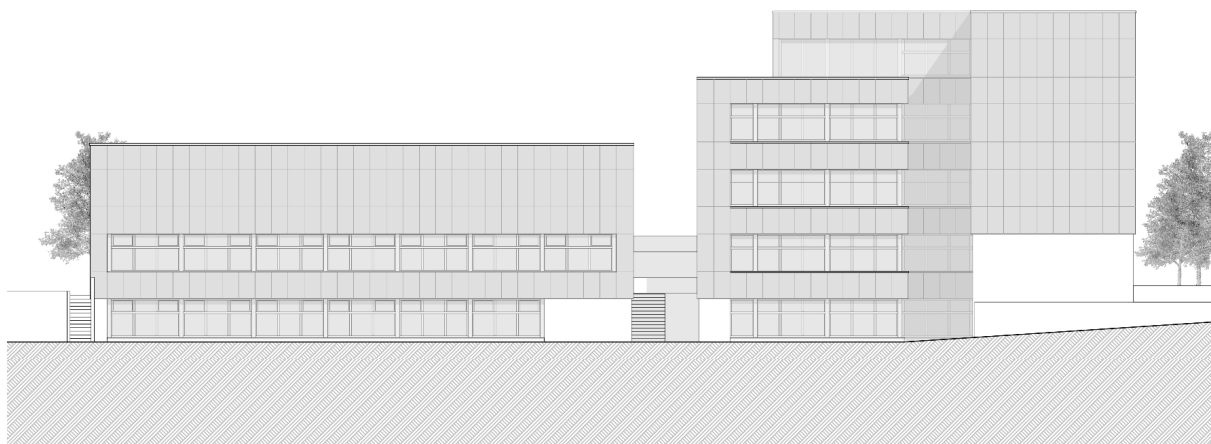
Ansicht Südwest (Sockelgeschosse = weisse Flächen | PV-Fassade = graue Flächen)
